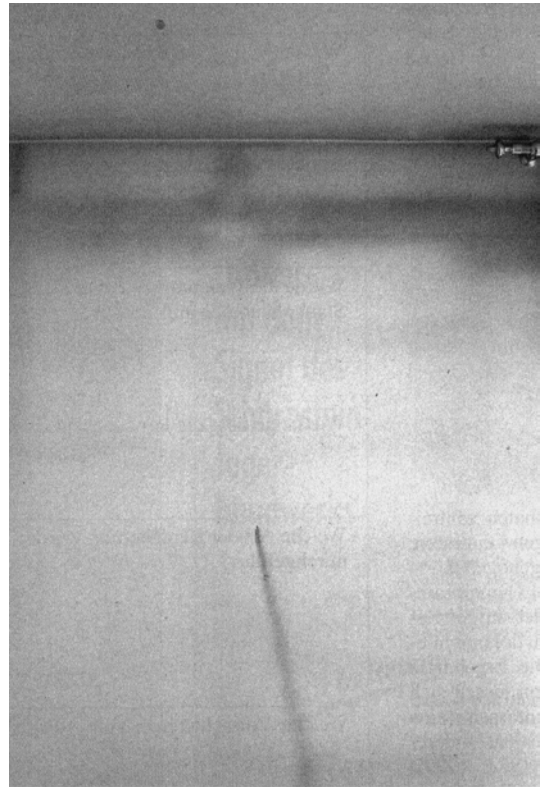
Schwarze Ablagerungen an Außenwand und Zimmerdecke in einer Neubauwohnung.
